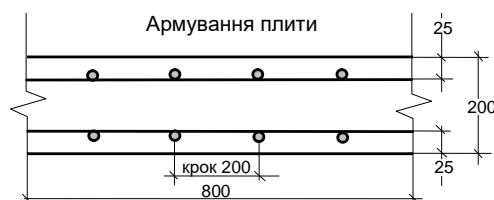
Конструктивна схема фрагменту залізобетонної плити перекриття ПМ-1.
